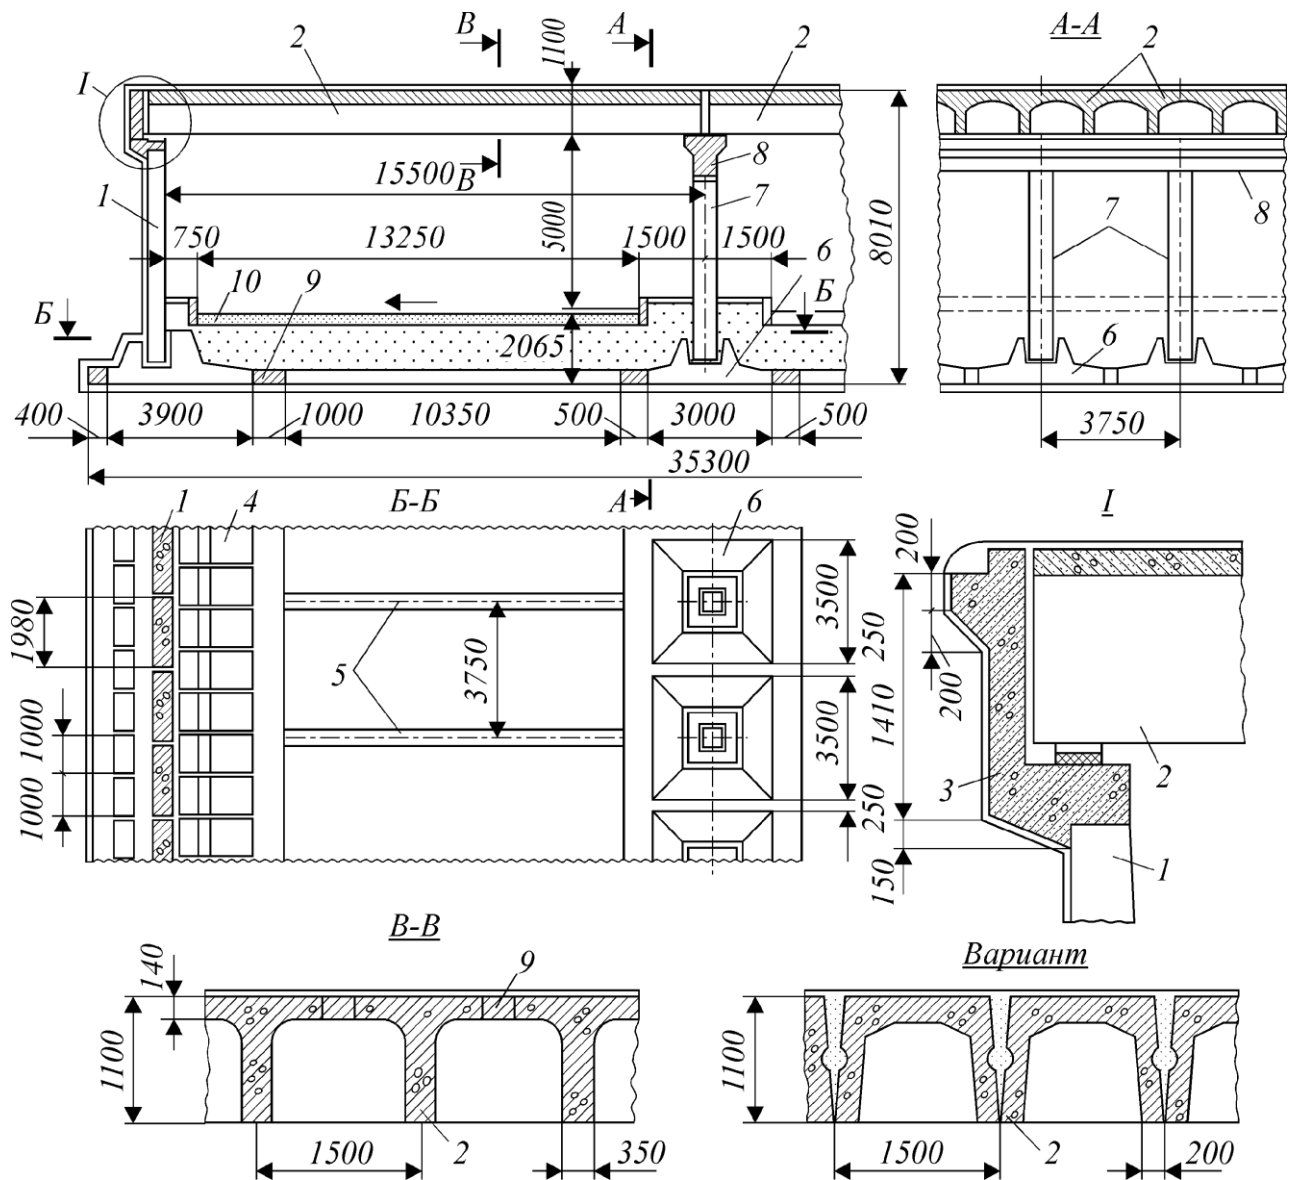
Конструкція транспортного тунелю із типових збірних залізобетонних елементів: 1– стіновий блок; 2 – блок перекриття; 3 – шафна стінка; 4 – фундаментний блок; 5 – балкова розпірка; 6 – підколонник; 7 – колона; 8 – прогін; 9 – ділянка омонолічування; 10 – проїжджа частина
